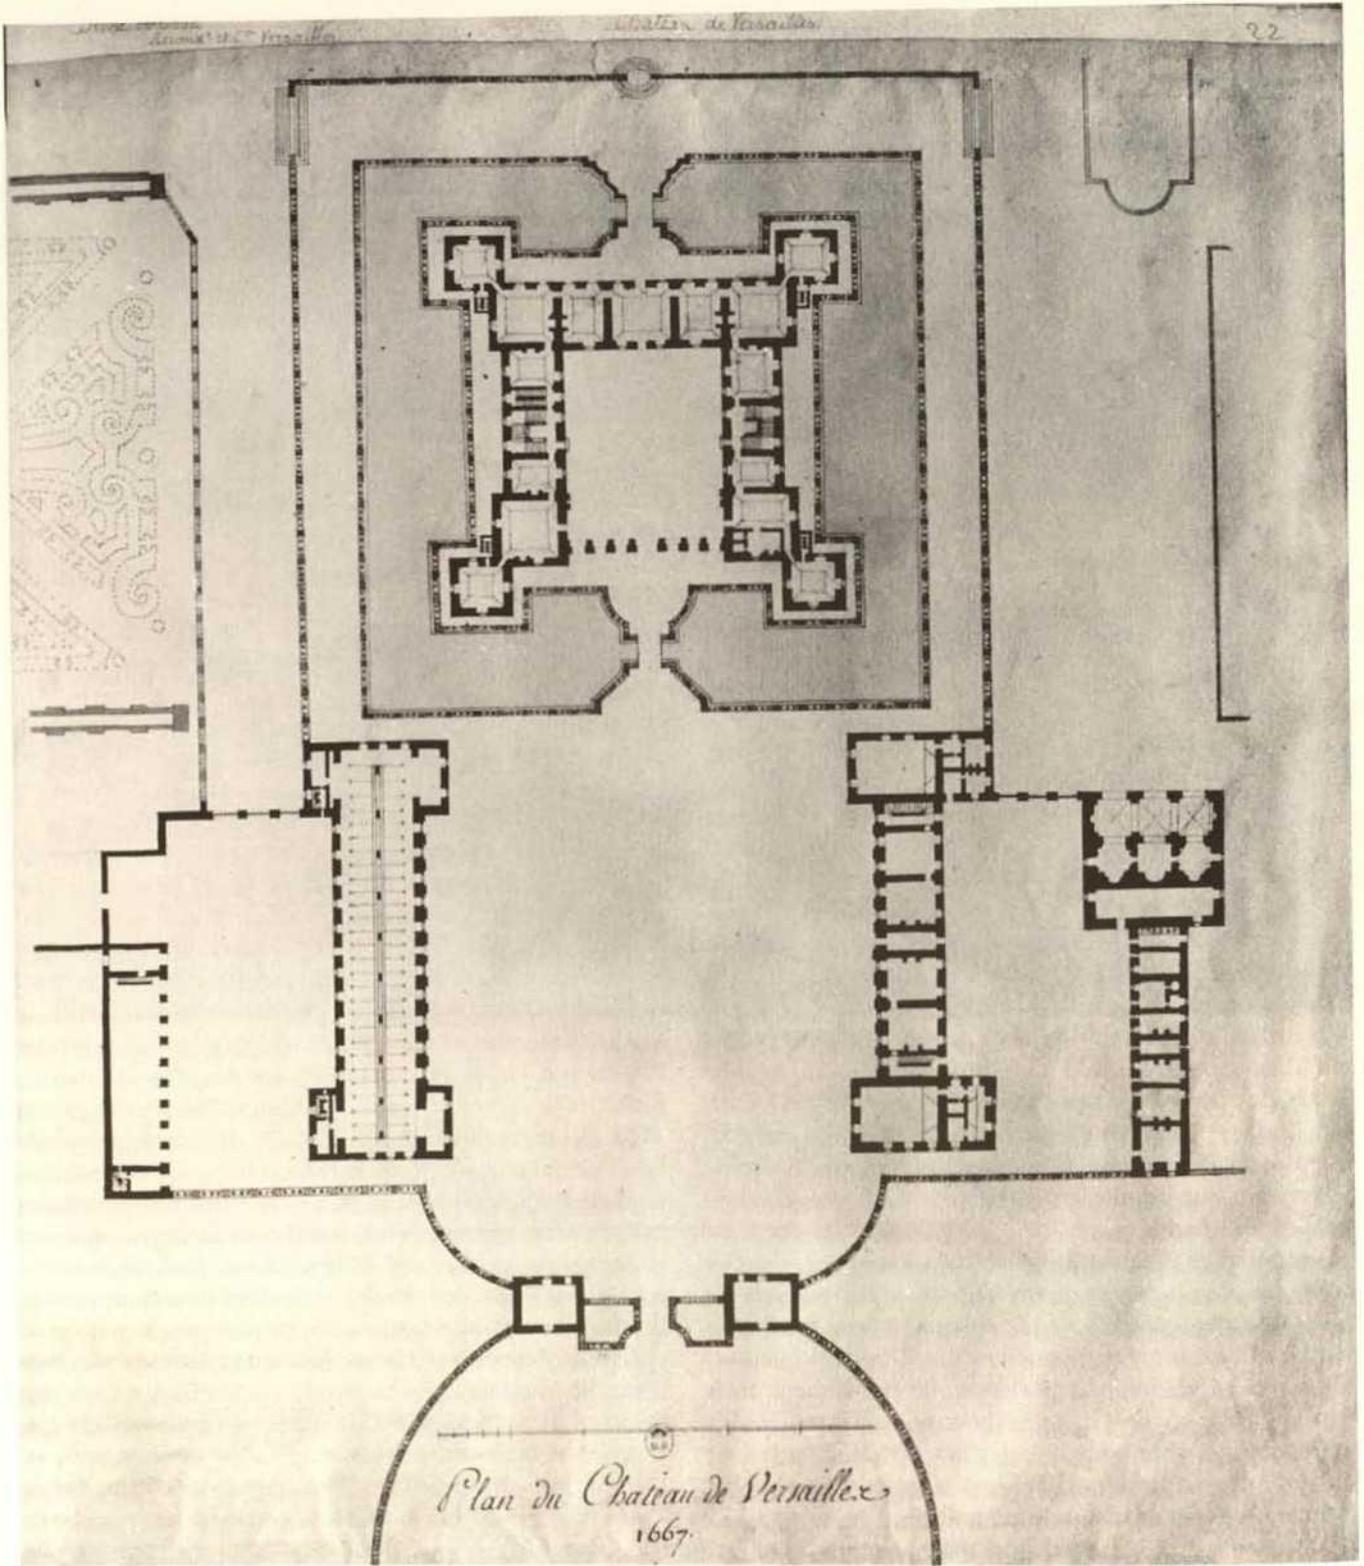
Schloß Versailles 1667, Gesamtplan mit Grundriß des Erdgeschosses
